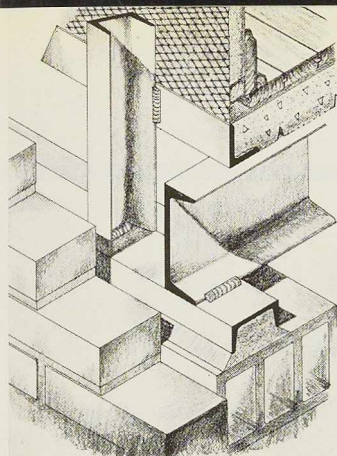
Perspective montrant le mode d'appui des panneaux de murs du rez-de-chaussée sur les maçonneries de fondation, ainsi que la constitution des murs extérieurs et des hourdis de plancher.
